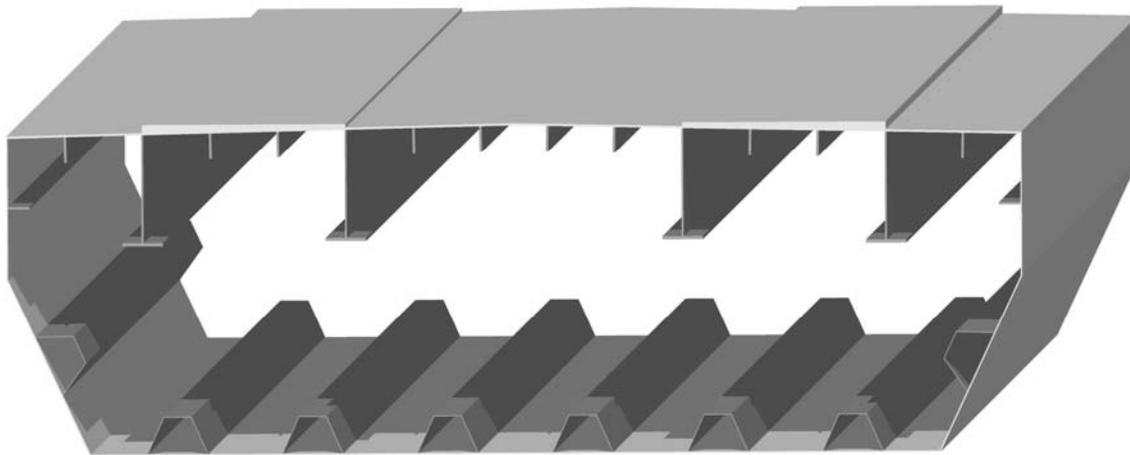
Sezione trasversale tipica dell'impalcato sospeso (ferroviario).
